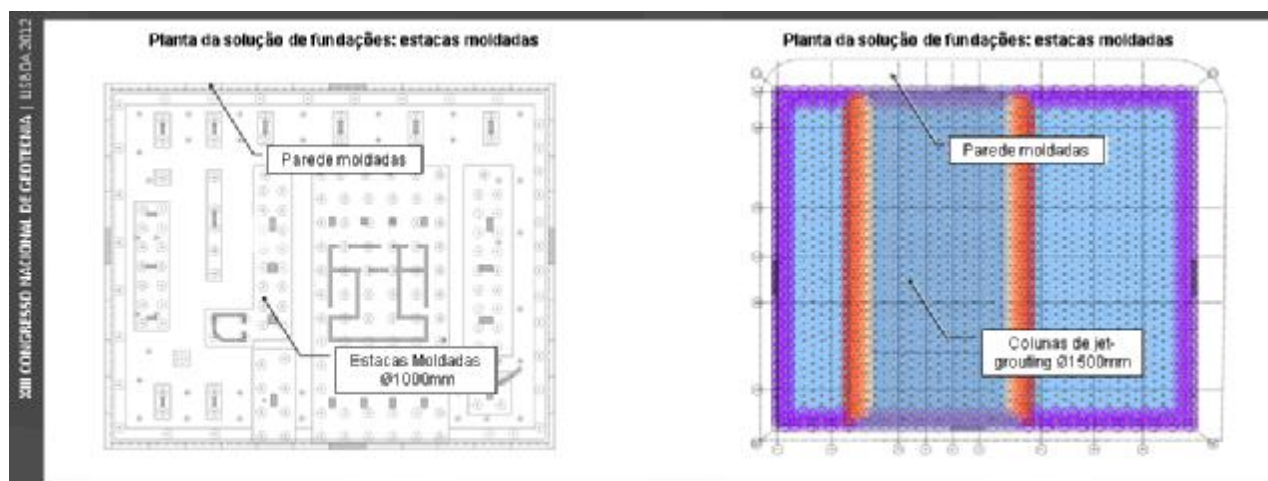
Planta da solução de fundações – estacas moldadas. Planta do tampão em jet-grouting.
